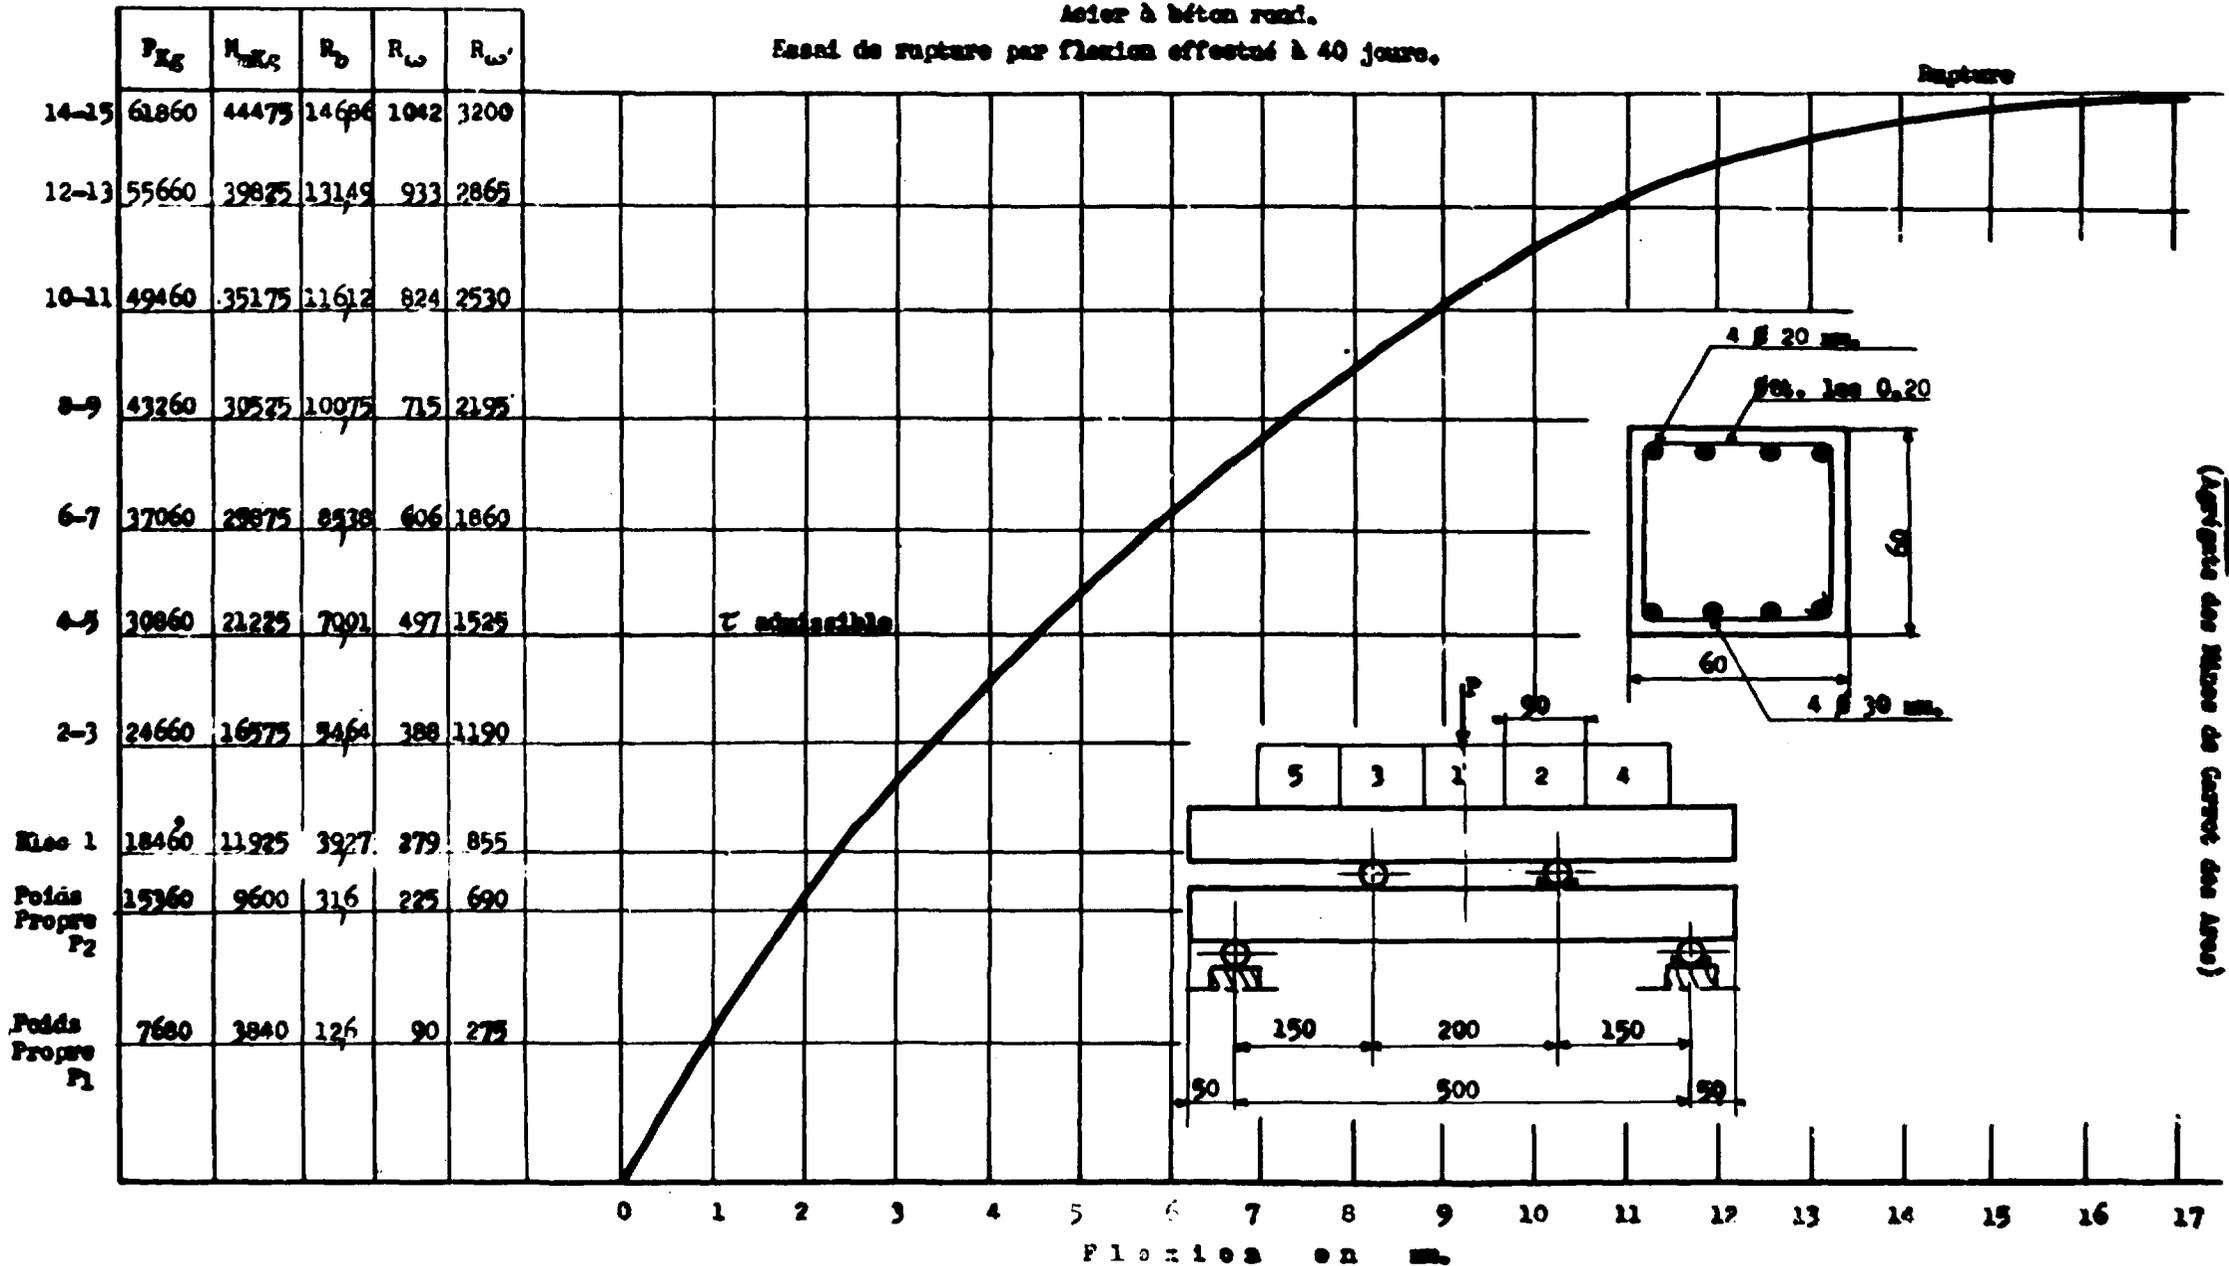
BEAU DE BARYTINE - Essai de rupture par flexion sur poutre en béton armé. (Agrégats des Mises de Carrot des Armes)
